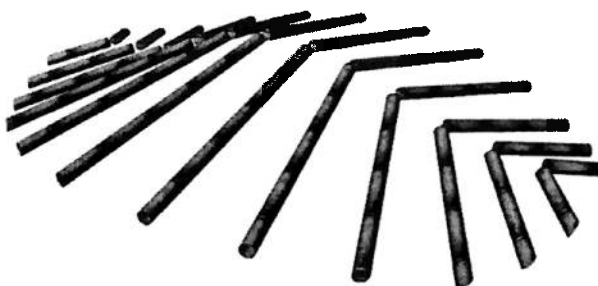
Rendering, perspectiva vigas de apoio por unidade.
